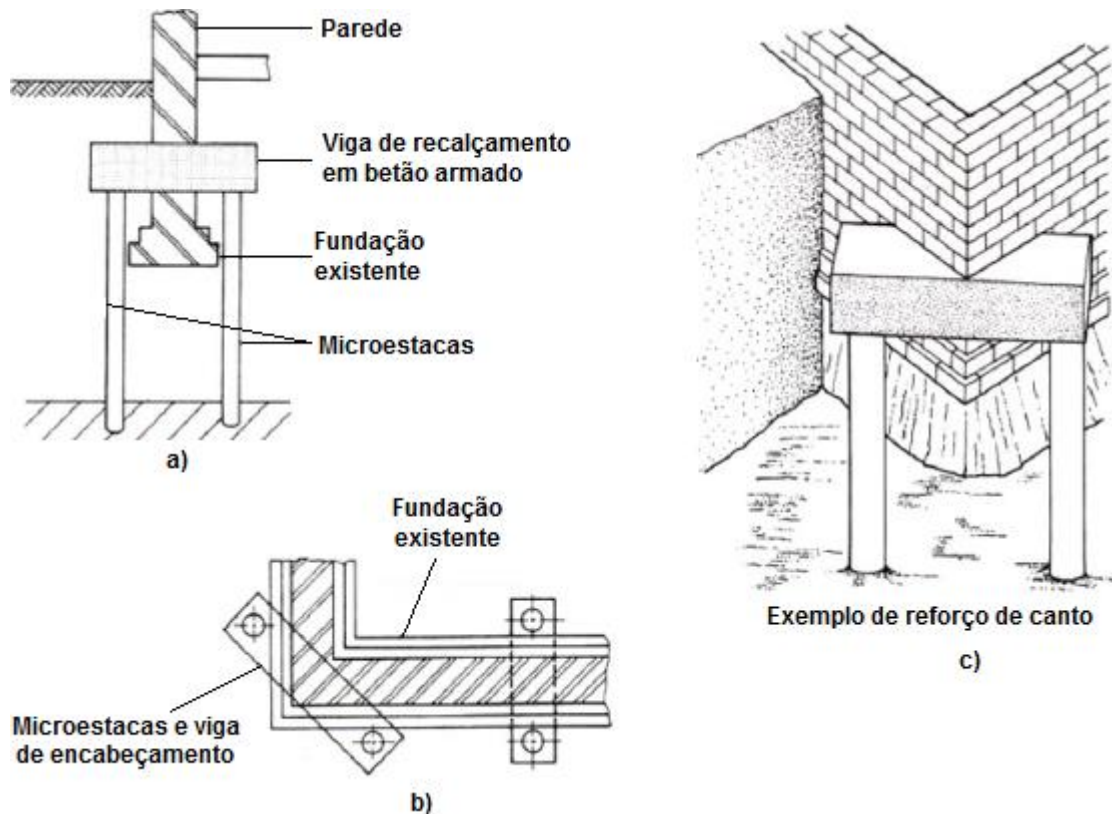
Esquema de recalce de fundações com microestacas encabeçadas por vigas de betão armado que atravessam a fundação existente ou a parede que suporta: a) alçado; b) planta; c) perspectiva [1]
